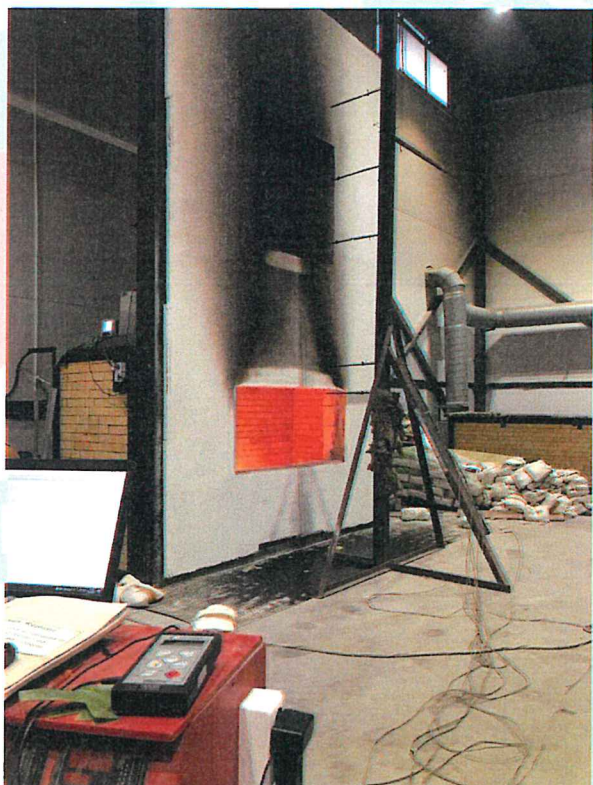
Внешний вид образца на 45-й минуте испытания.
